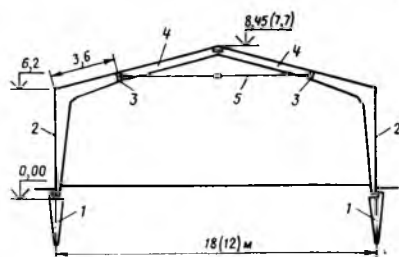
Железобетонная рама с повышенными стойками пролетами 18 и 12 м
